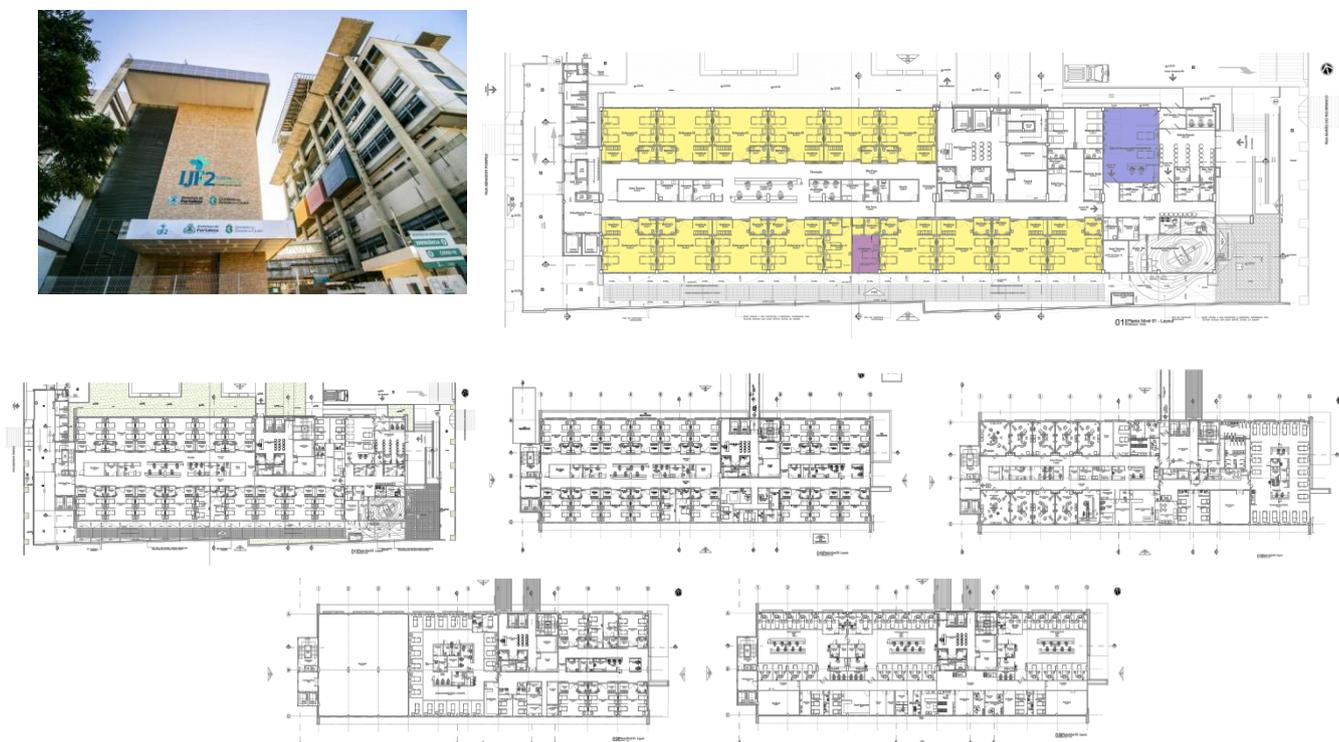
a,b,c,d,e,f,g: Fachada, planta setorização e Plantas e Layout dos pavimentos do Instituto José Frota 2. O detalhamento pode ser melhor visualizado em [https://drive.google.com/drive/folders/1q48oAaLqfci4ZLz\\_bHMYAec377zQrkbB](https://drive.google.com/drive/folders/1q48oAaLqfci4ZLz_bHMYAec377zQrkbB). Fonte: as autoras
